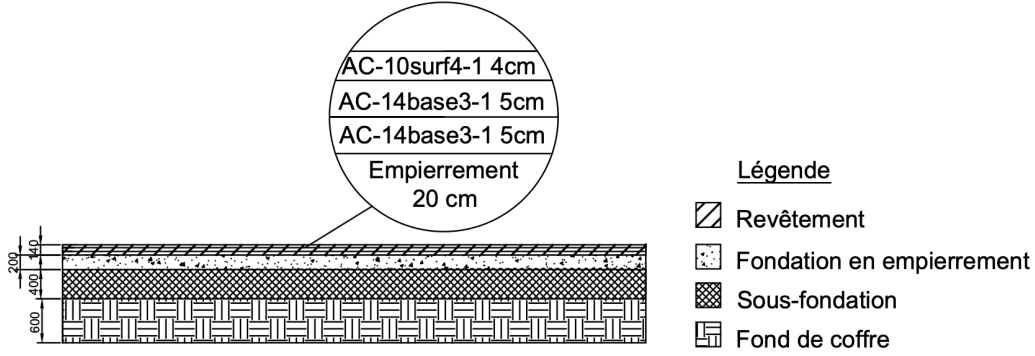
Schéma structure routière - infiltration par les drains latéraux
